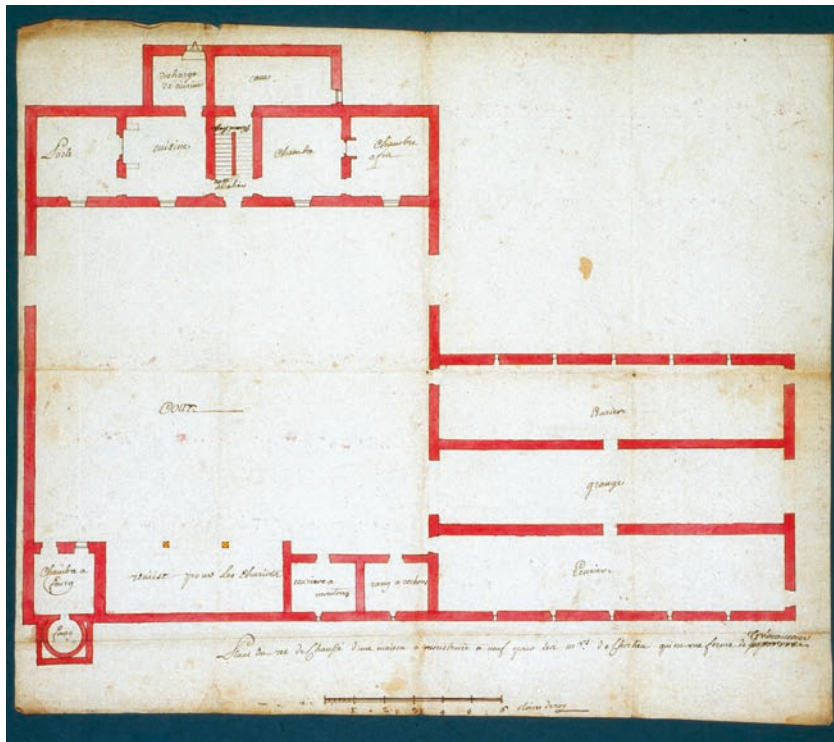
Trémoucourt : plan du rez-de-chaussée d'une maison à construire à neuf (1761, anonyme. ADHS, H. 250)
